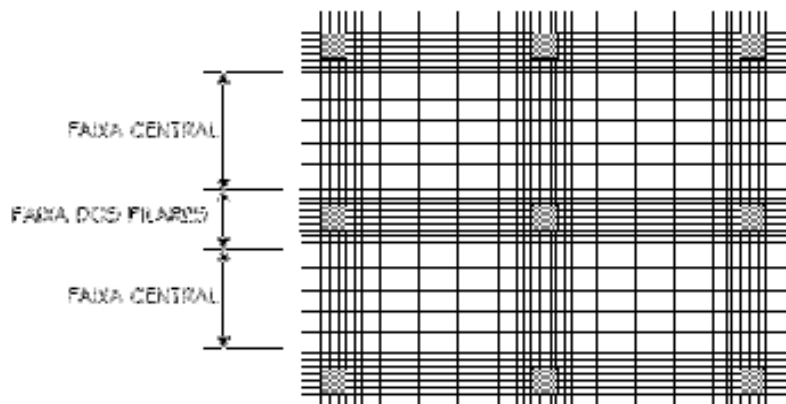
Distribuição dos Cabos em planta sugerida pelo Comitê 423 do ACI
